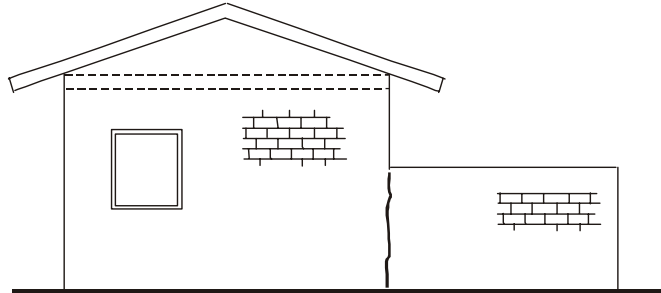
fissura vertical por deficiência de amarração entre o prédio e o muro
